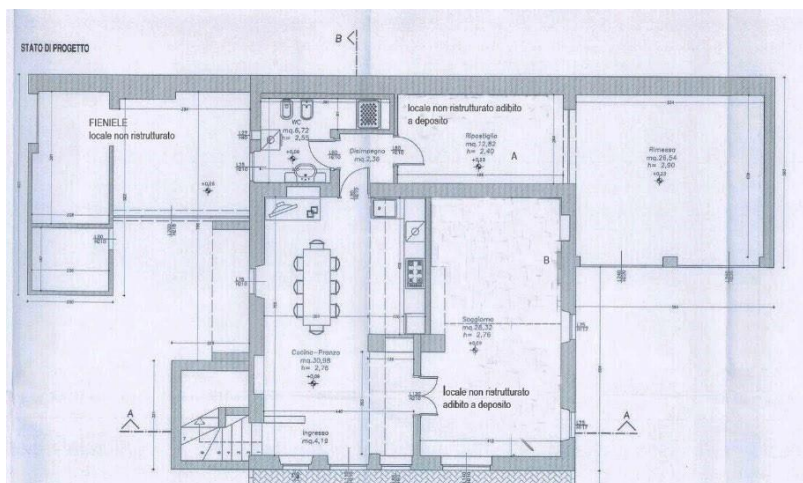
planimetrie con indicazione delle parti non ristrutturate
